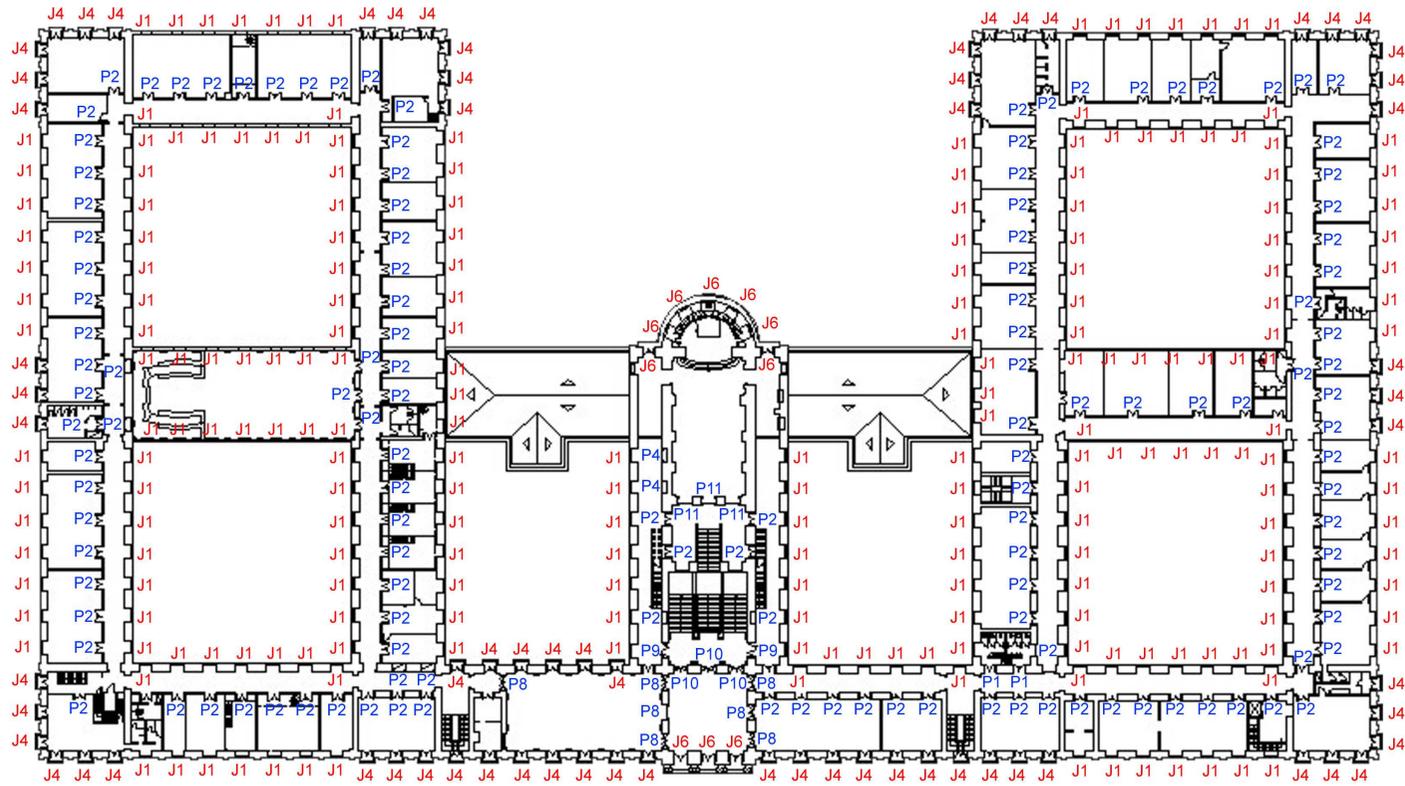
Planta de localização das portas e janelas do 2º pavimento.
